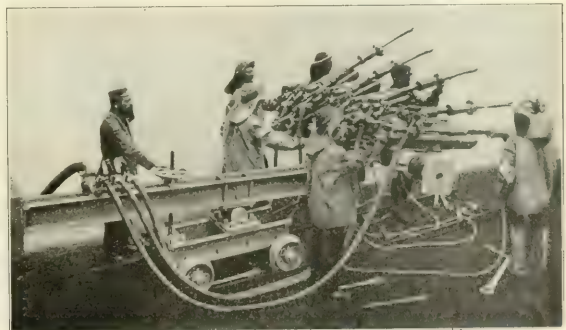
Bohrwagen mit Meyer-Maschinen.
